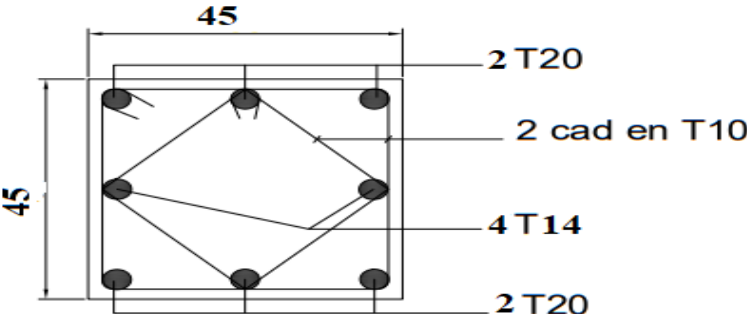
Schéma de ferrailage des poteaux de la 'ZONE 3'
